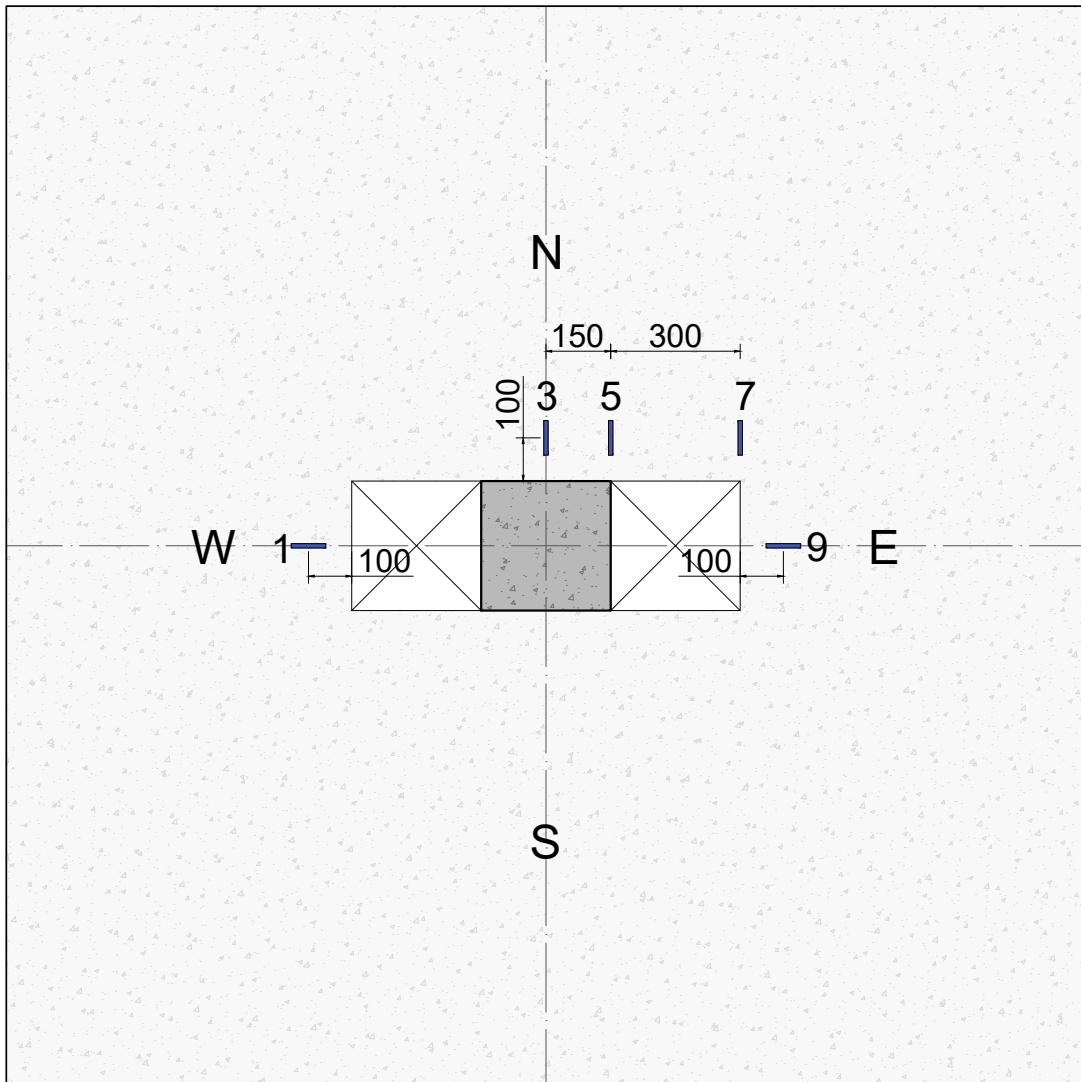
Posicionamento dos extensômetros radiais nas lajes com aberturas [mm]
